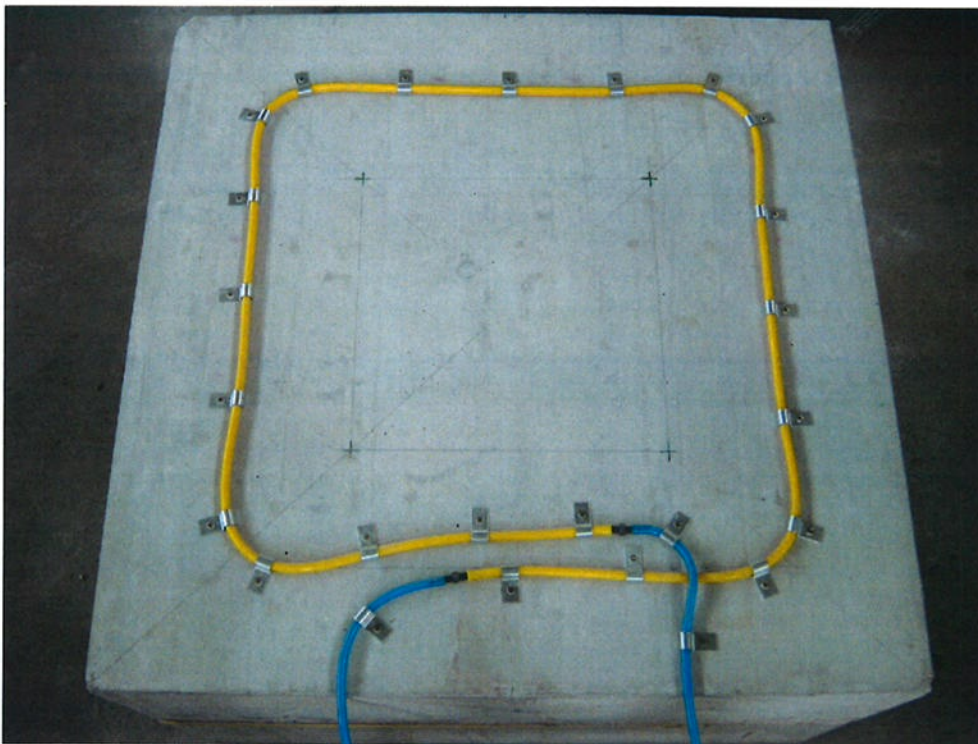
Tuyau d'injection MASTERTUBE YELLOW monté sur la dalle de base au centre du futur joint de construction
